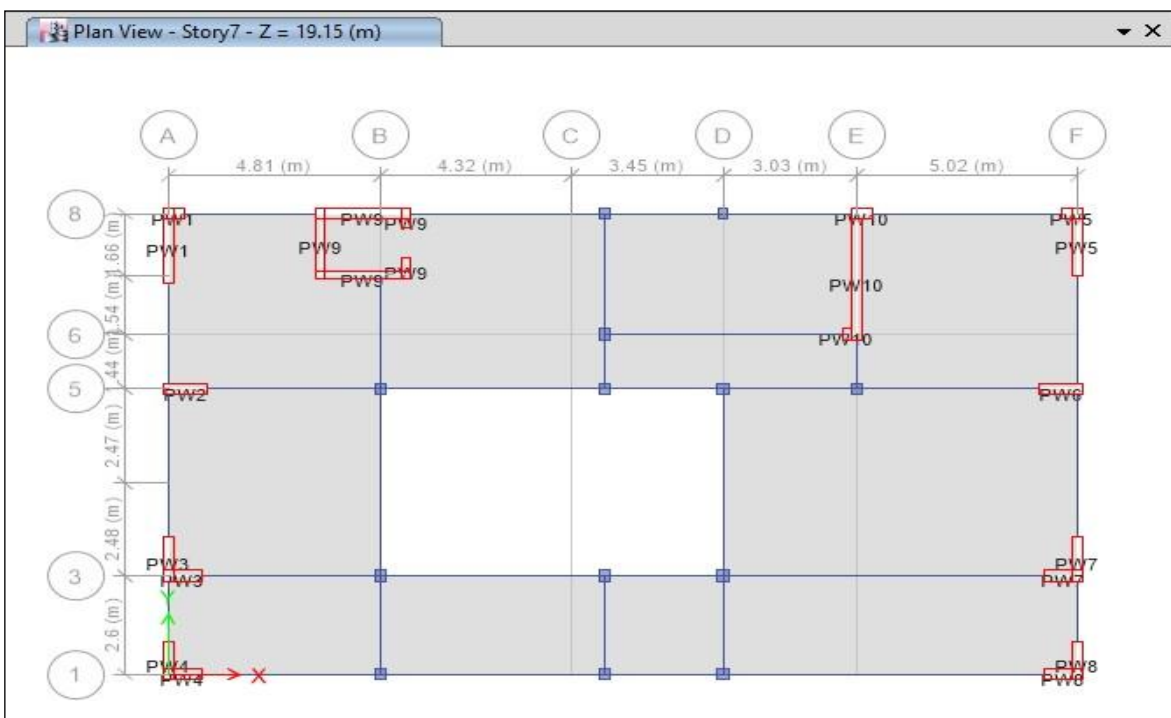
Distribución de los Muros de Corte en planta del 7º Piso de la Edificación “MARBELLA”.
